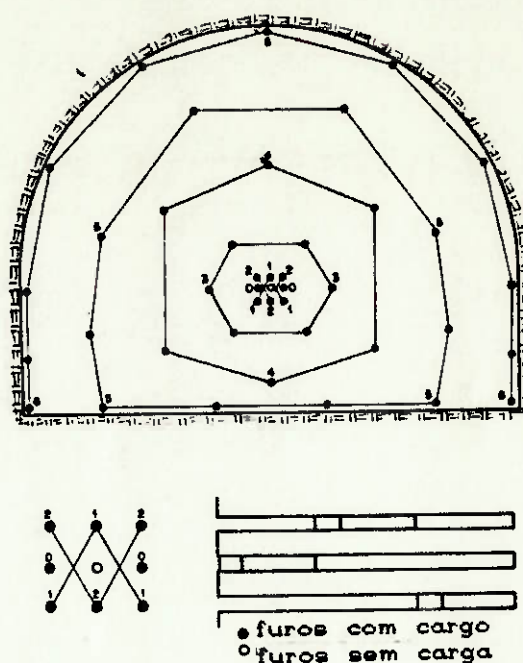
Plano de fogo com pilão Sarrois.
